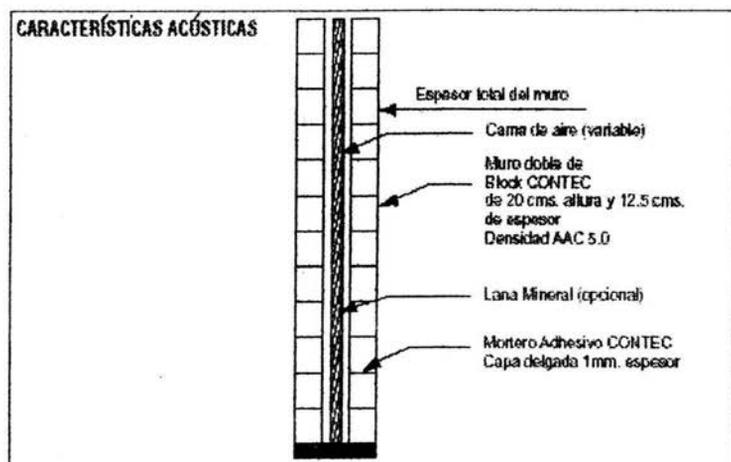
En la figura se muestra un muro doble con aislamiento intermedio de lana mineral, a este sistema de muro se le aplicaron pruebas de aislamiento acústico por parte de la Acoustic Systems, STC (Sound Transmission Class) y la OITC (Outdoor Indoor Transmission Class)
